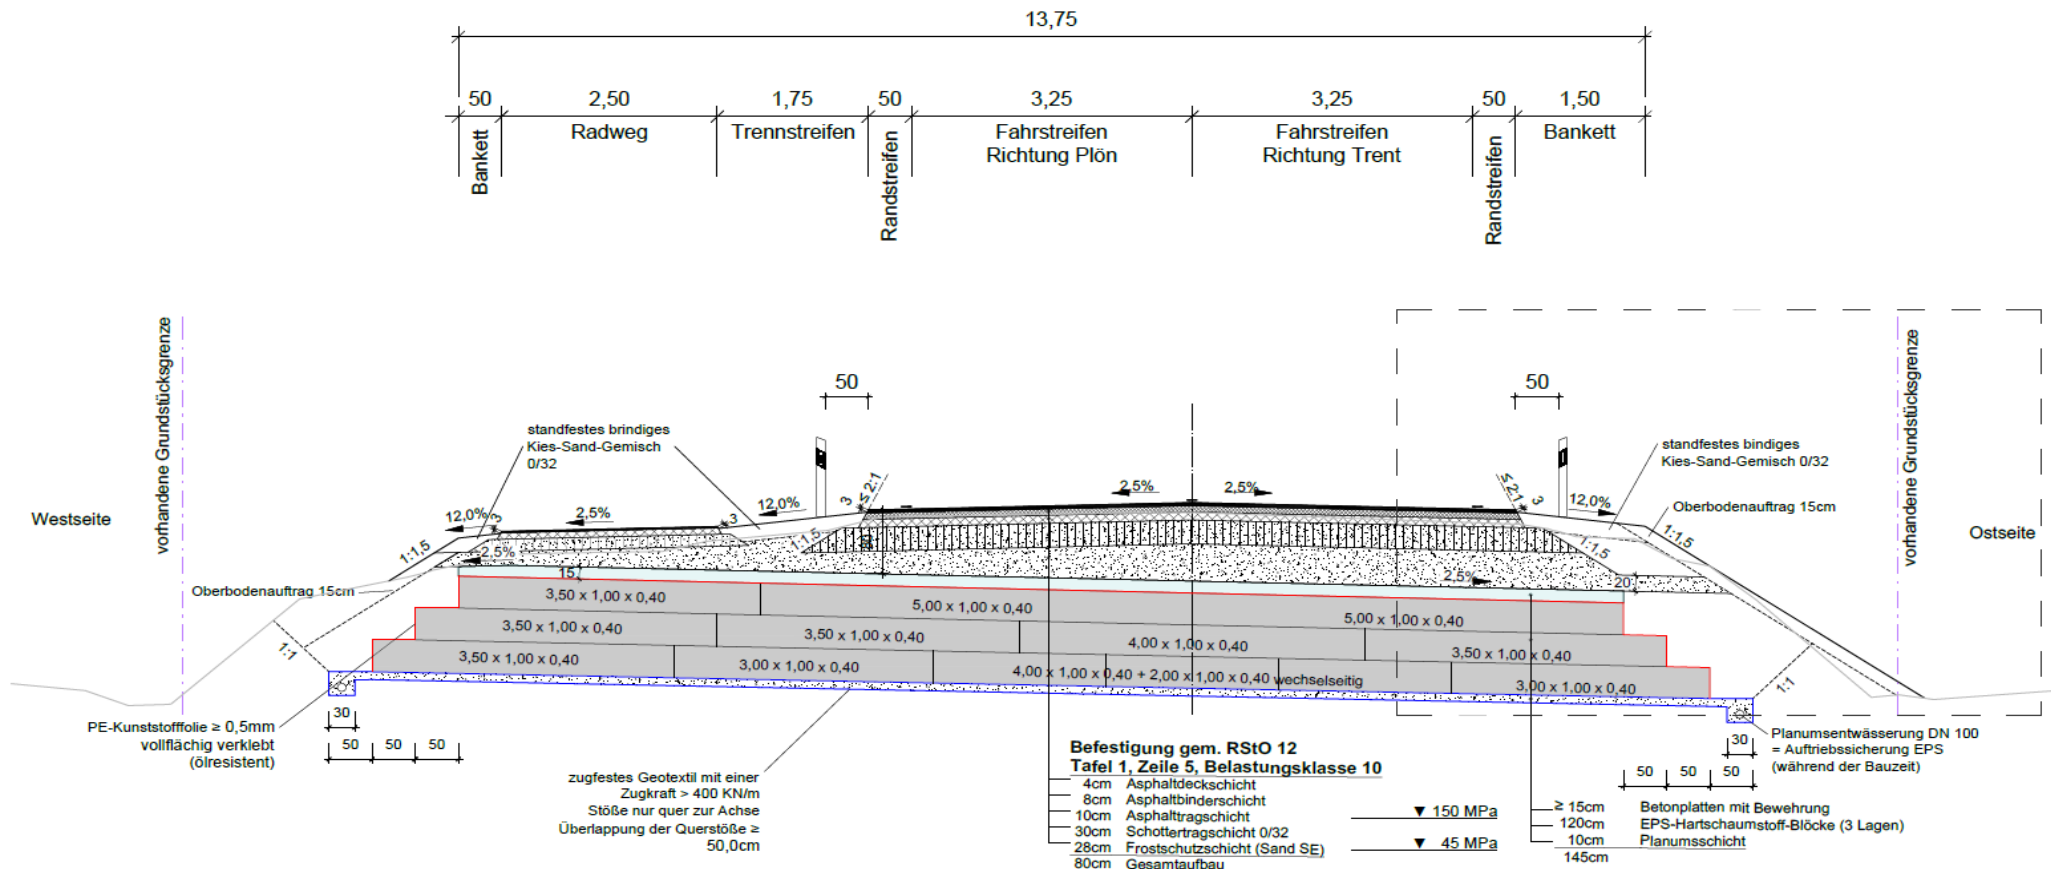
Lageplan Grundhafte Erneuerung mit Planumsverbesserung
